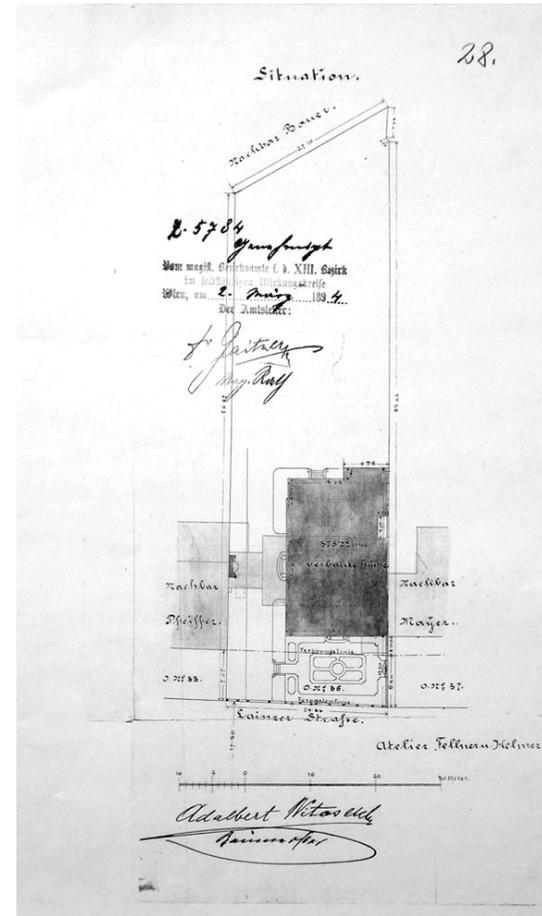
(rechts): Villa Geitler. Situationsplan. 1894. Einreichplan.
